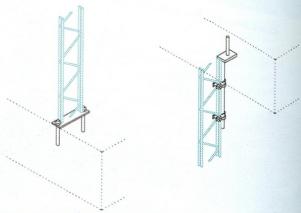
Fijación AllWall inferior Alfa. Fig. 5b: Fijación AllWall superior Beta.
